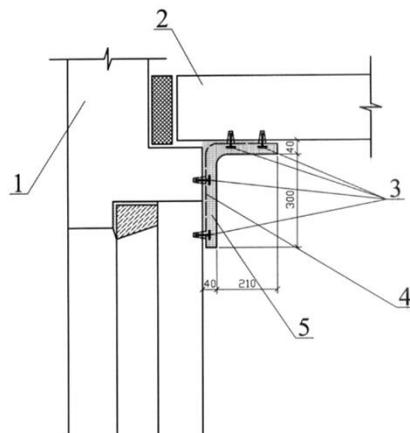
Утепление карнизного узла: 1 – наружная стеновая панель; 2 – плита перекрытия; 3 – дюбеля в деревянных пробках; 4 – штукатурная сетка; 5 – теплая штукатурка
